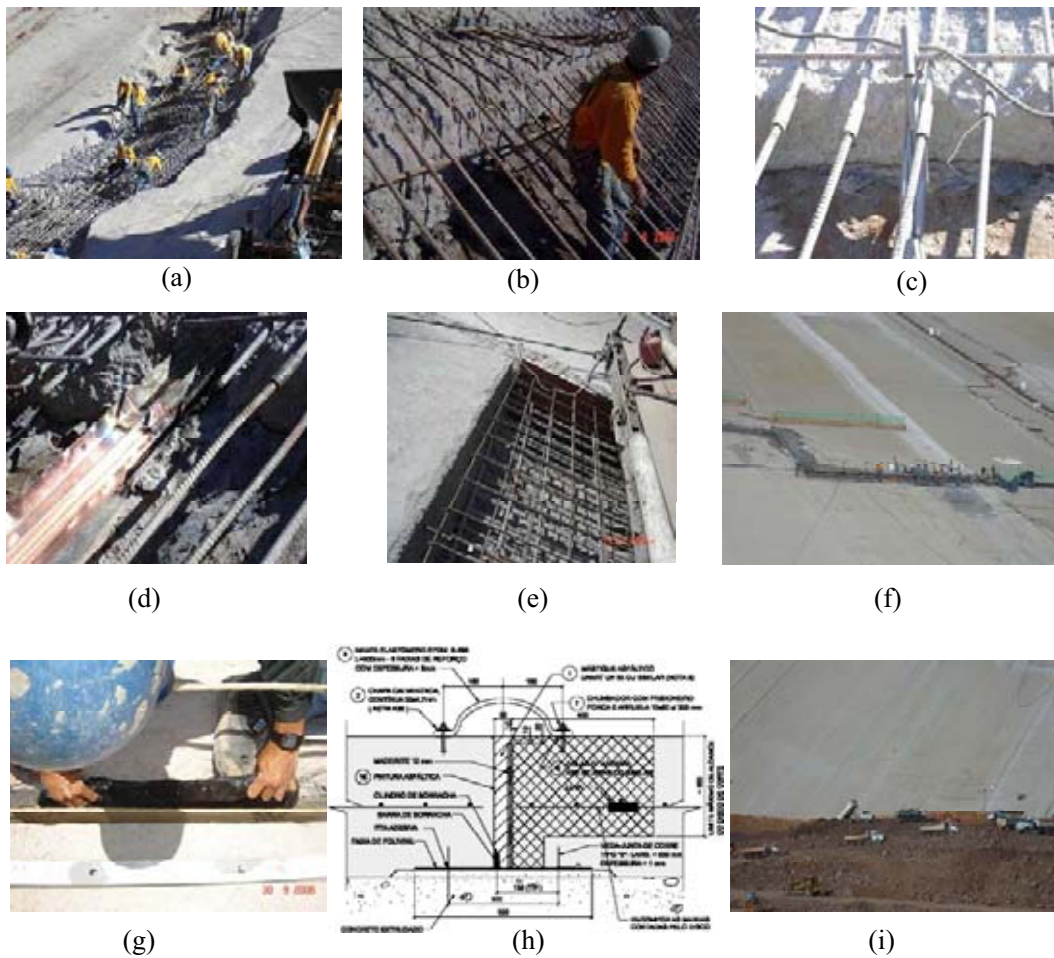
Recuperação da face de concreto da barragem de Campos Novos: (a) rompimento do concreto; (b) rompimento das armaduras; (c) substituição das armaduras; (d) recomposição das juntas; (e) armadura complementar na face superior; (f) concretagem; (g) aplicação de mastique; (h) aplicação de manta EPDM; (i) execução de aterro.
